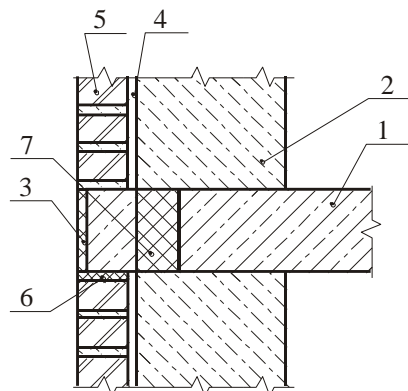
Вариант сопряжения лицевого слоя с плитой перекрытия:
